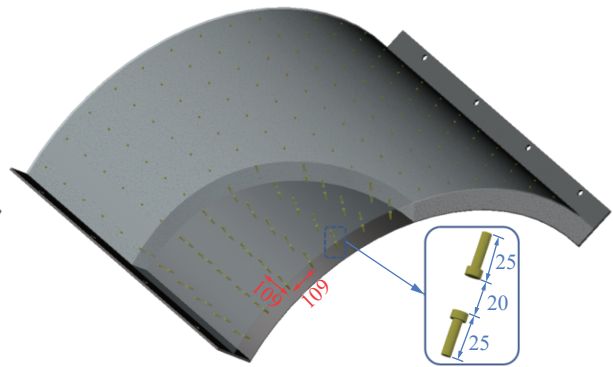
栓钉弧形双钢板混凝土组合板 (CSCS-ST) 结构形式 (单位: mm)
